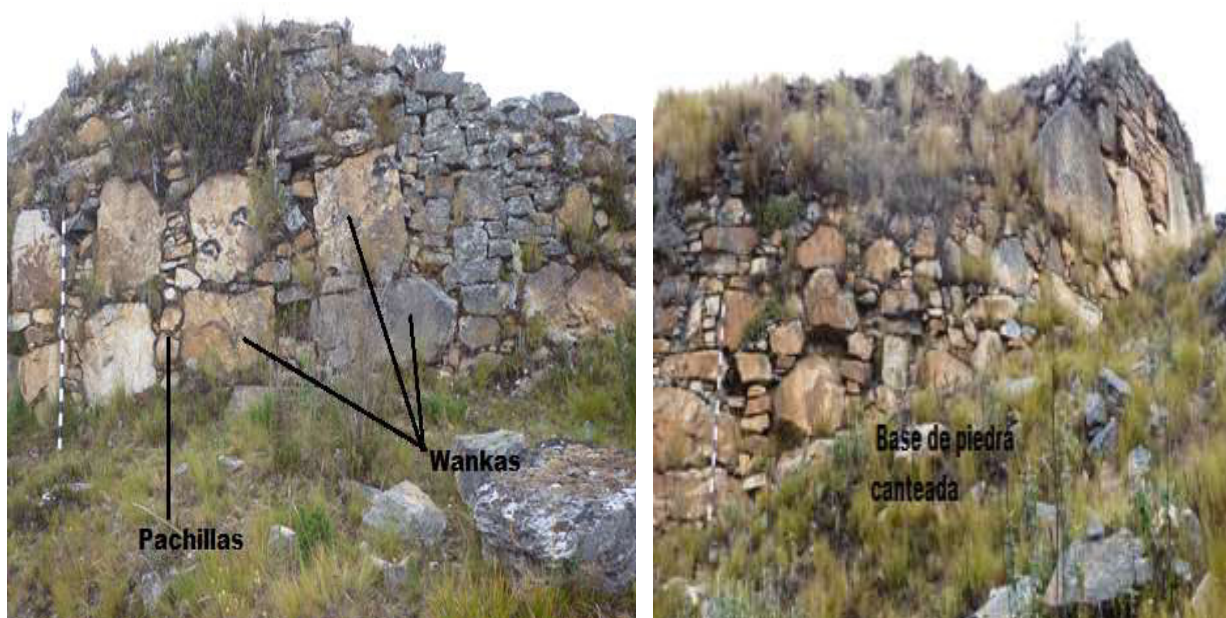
Técnica constructiva de la Wanka/Pachilla sobre una base de piedras canteada pequeña en Pueblo Viejo
